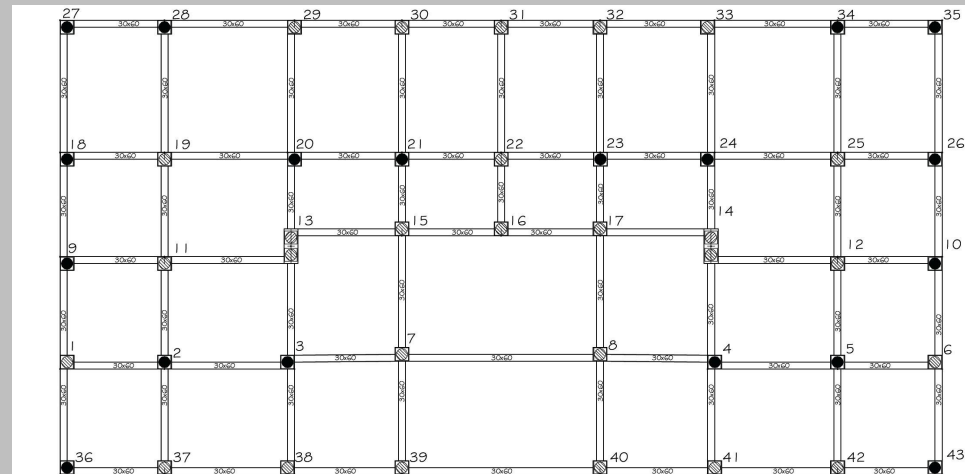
Pianta del sistema di isolamento (e scorrimento)
